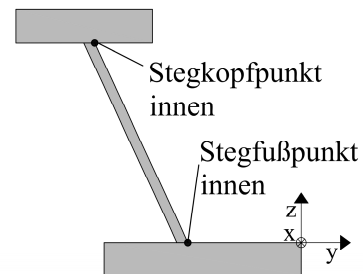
Skizze des Brückenquerschnitts mit der Lage der untersuchten Stellen
